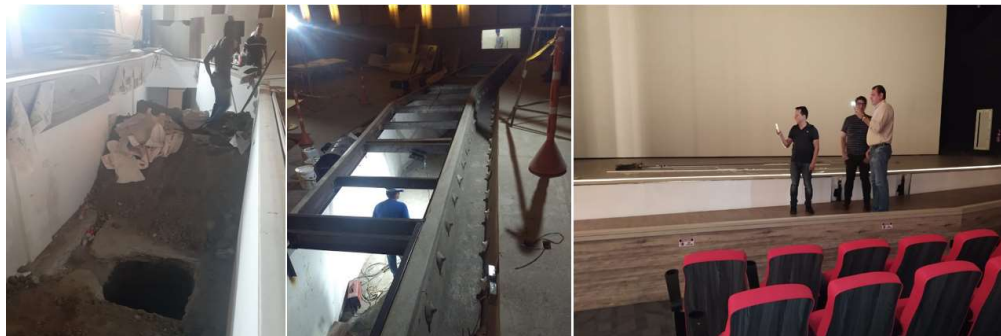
Instalación del superboard sobre la estructura metálica y aplicación de estuco sobre superboard. Elaboración propia.
